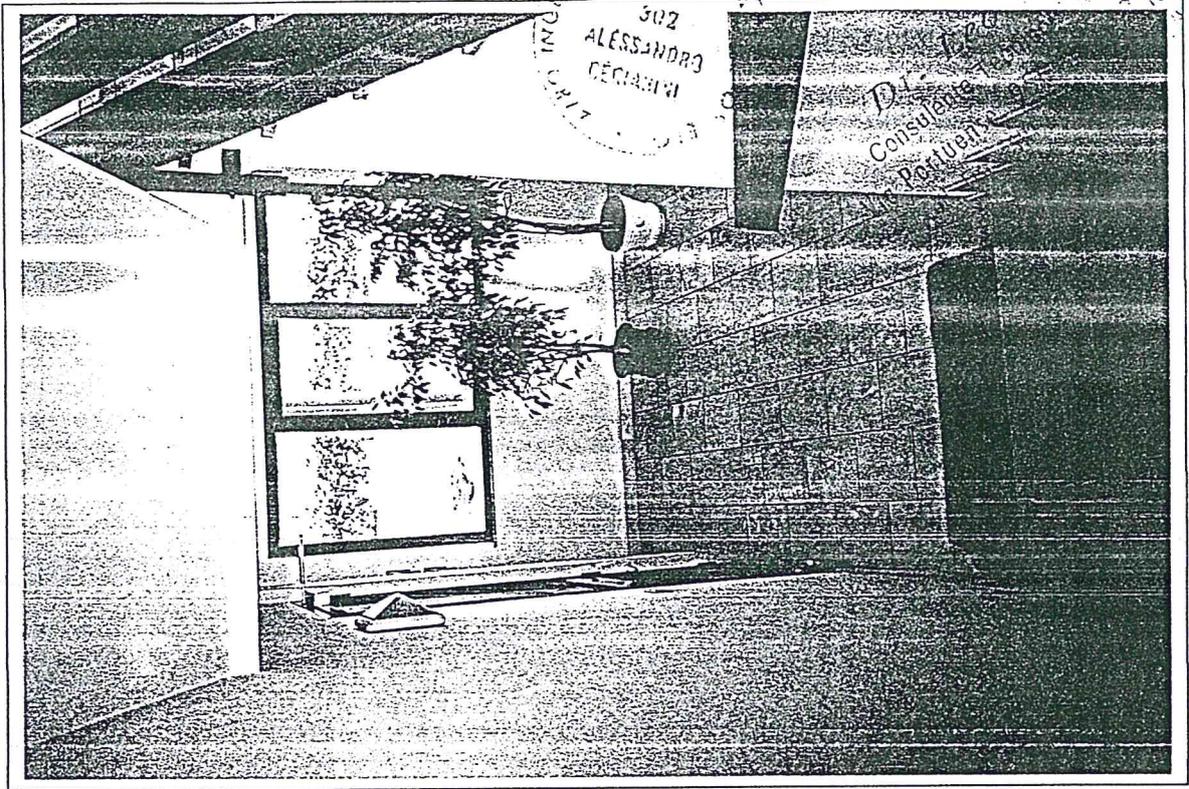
Corridoio di ingresso del vano scale al piano terra, tipico per tutti vani scala.
